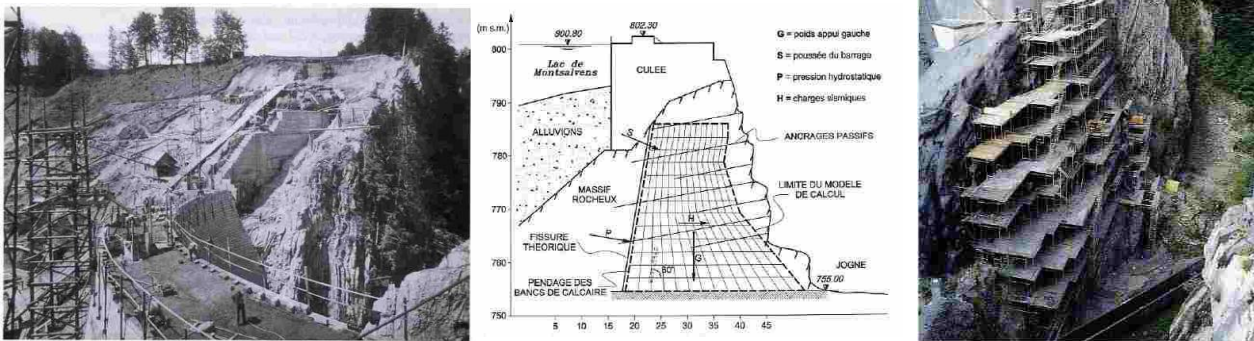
Barrage de Montsalvens. Construction. Principe du confortement. Réalisation des travaux.
